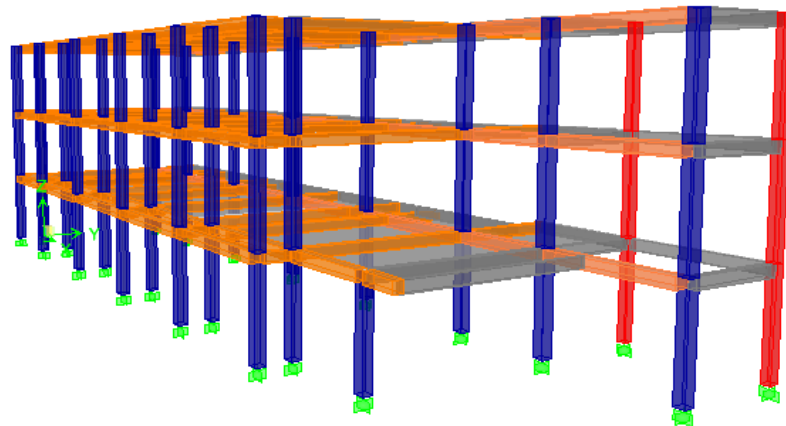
Sistema Reforzado con Pórtico Adosado – Vista 3
